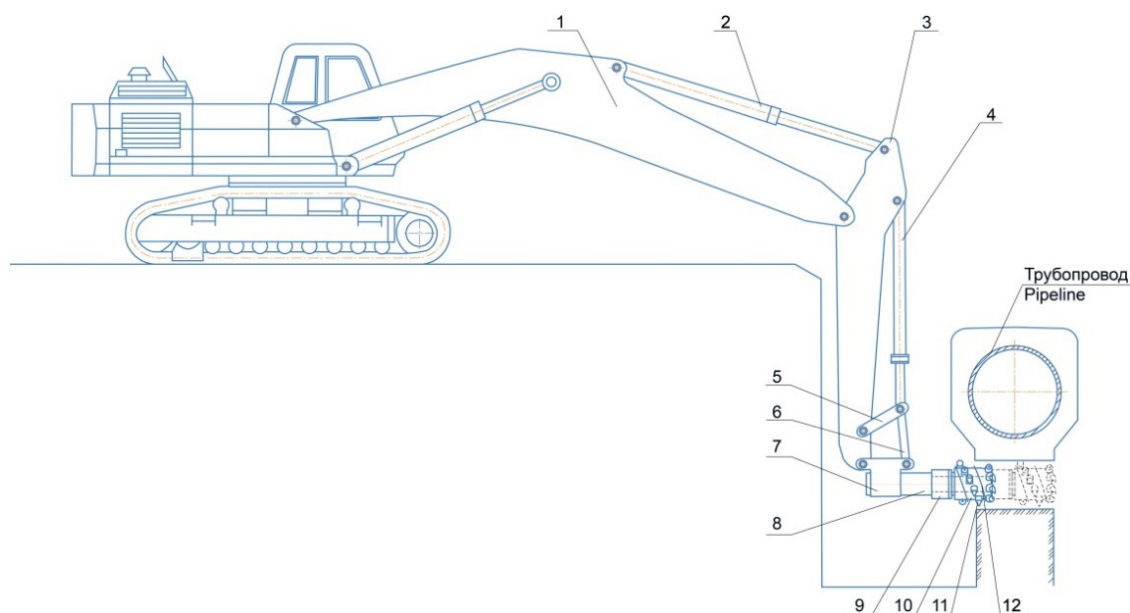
Экскаватор со сменным фрезерным оборудованием:
